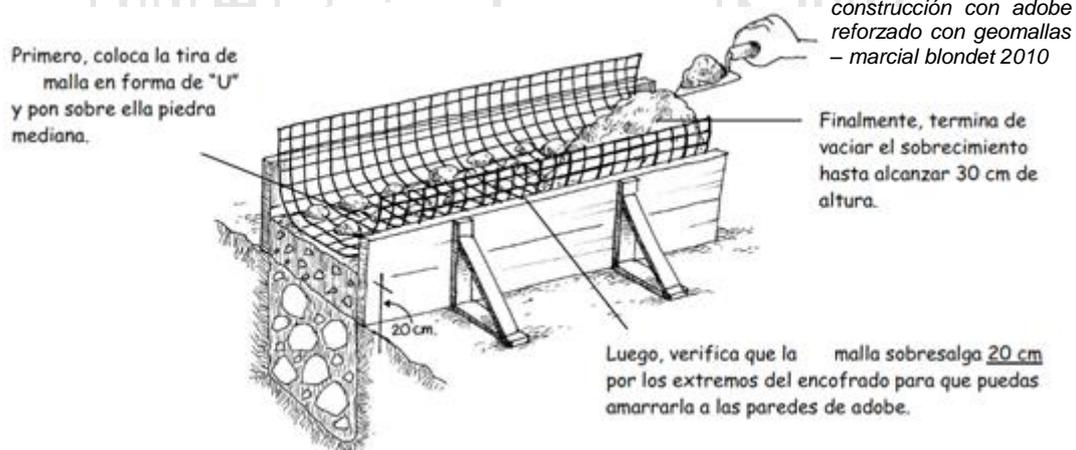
Colocación de malla electrosoldada en muros.
